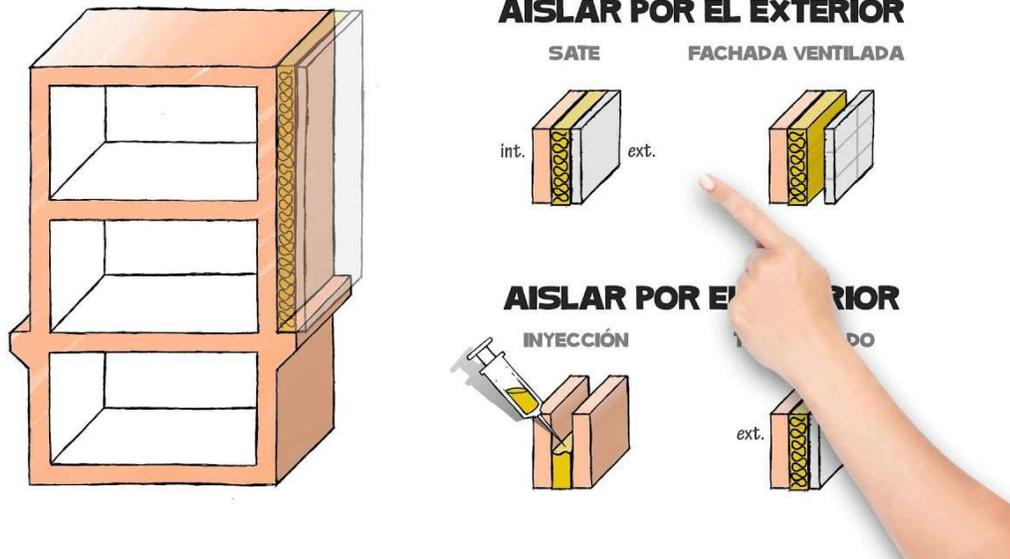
Aislamiento para muros de fachadas eficientes.
